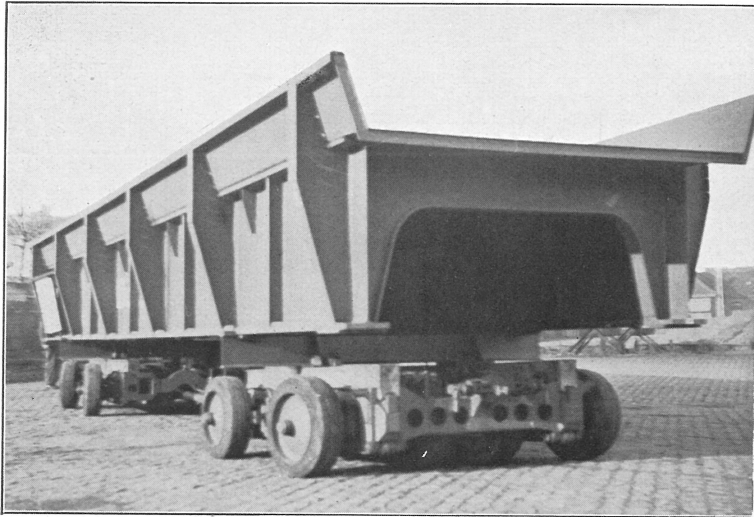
Beförderung einer geschweißten Brücke auf dem zweiteiligen Straßenfahrzeug der Reichsbahn
